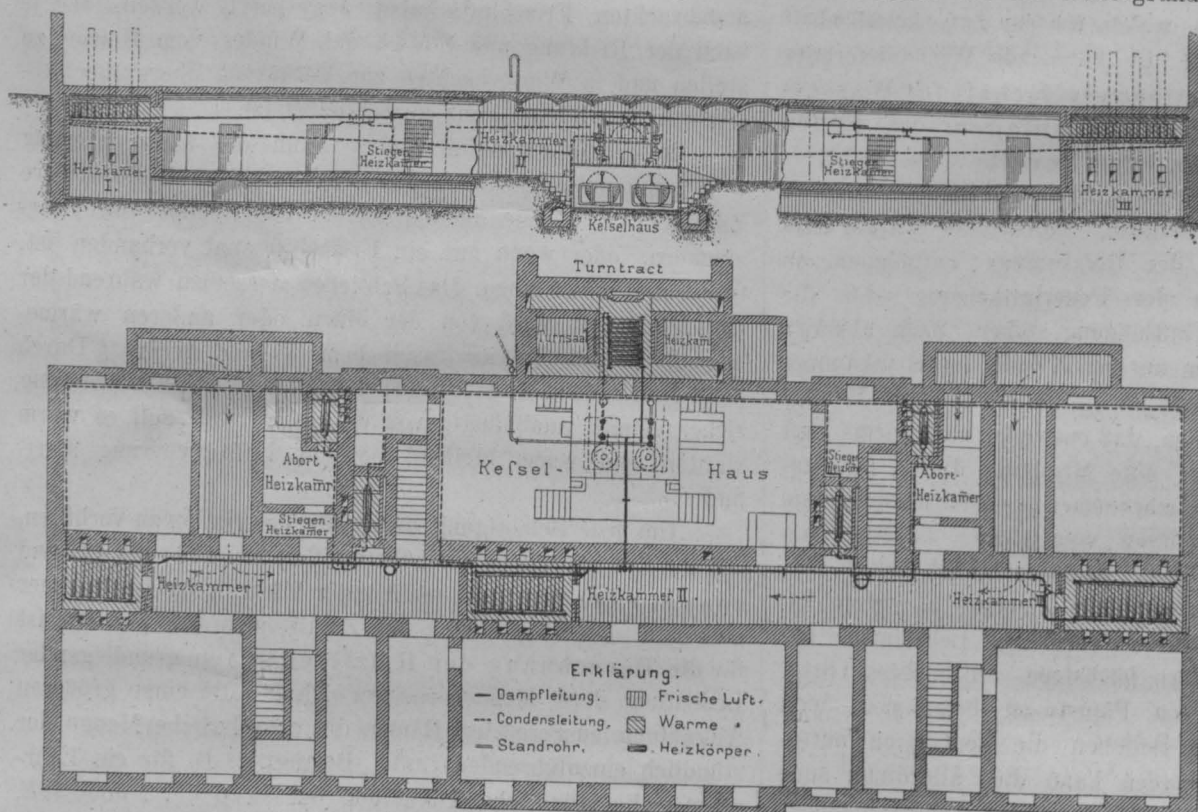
Längsschnitt und Grundriss der Schule V. Bez, Embelgasse.
